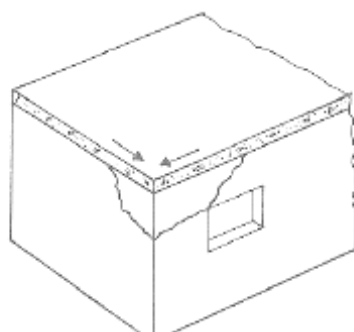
Trincas de cisalhamento provocadas por expansão térmica da laje de cobertura (Fonte: THOMAZ)
